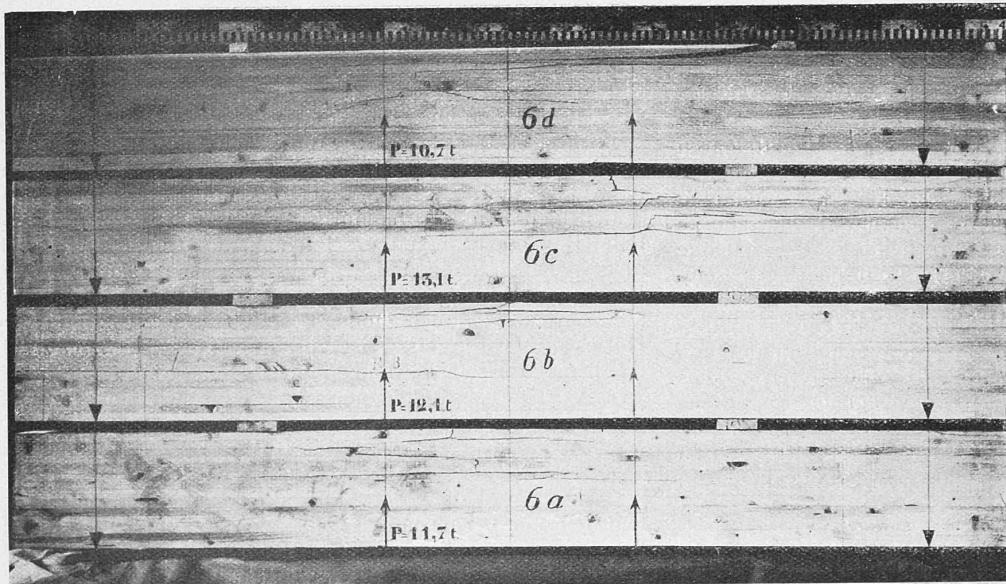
Ansicht der Probekörper Typ 6 nach dem Bruch.
